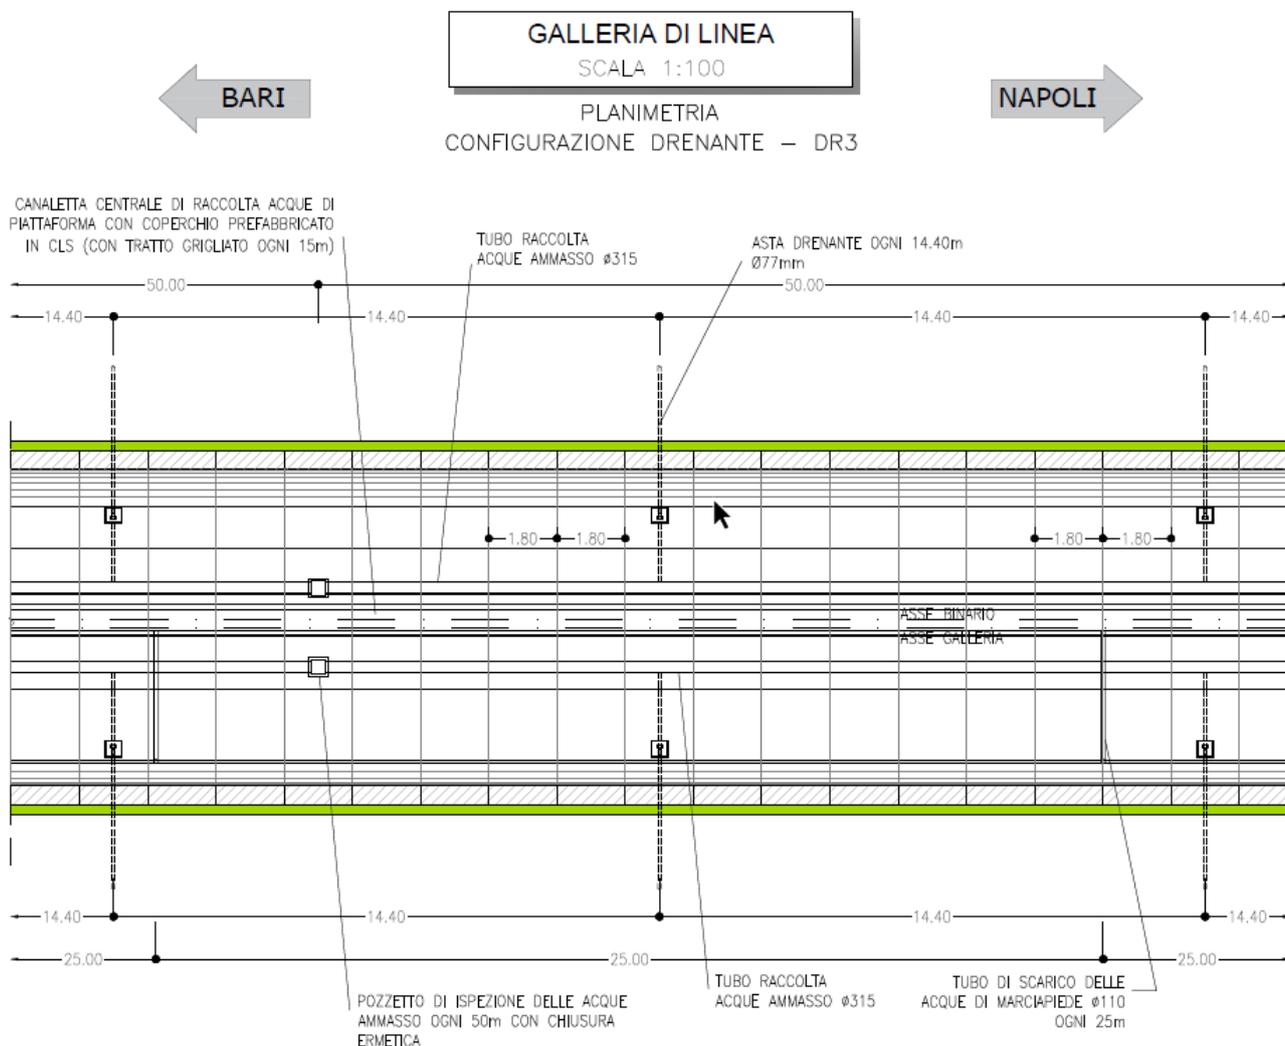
Sistema di drenaggio acque d'ammasso – DR3 (planimetria)
